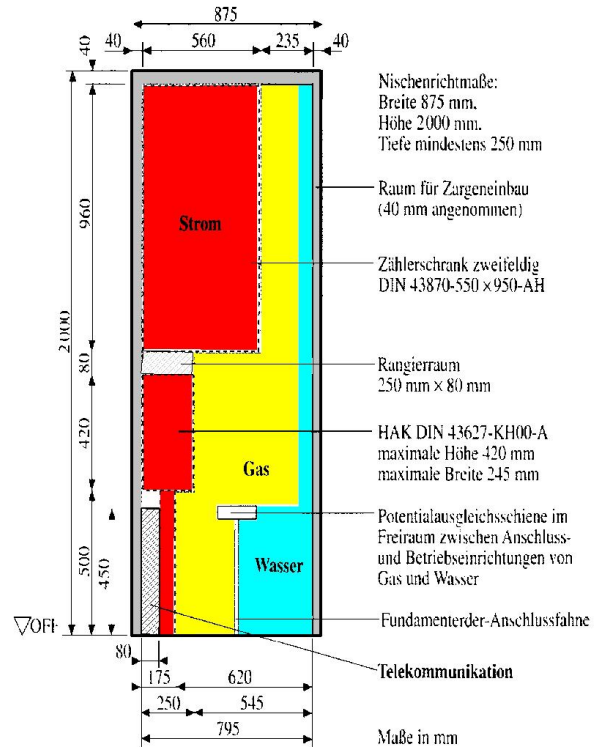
zeigt ein Beispiel eines Hausanschlussraumes mit Einzeleinführungen, Bild 2 verdeutlicht die Abmessungen einer Hausanschlussnische, in Bild 3 sind die Hausanschlüsse unter Verwendung einer Mehrspartenhauseinführung dargestellt.
